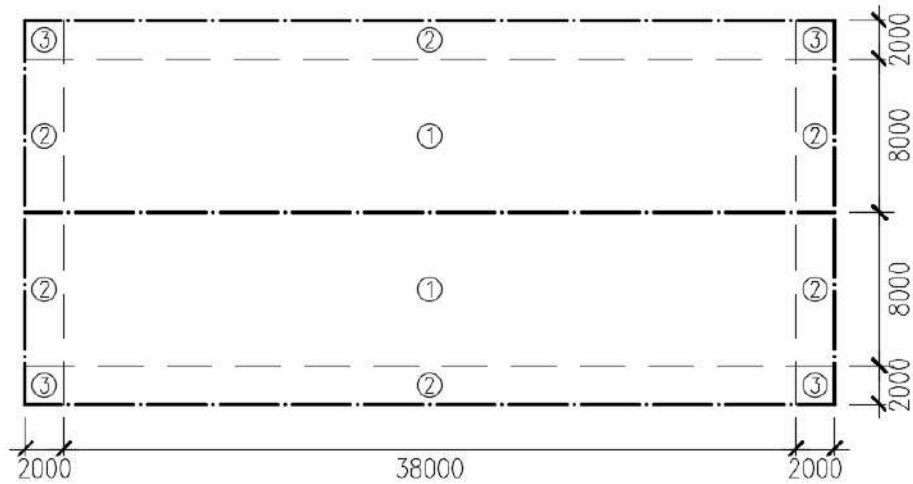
Esquema zonas de correas planta (CyR) (medidas en mm). Fuente: elaboración propia.
